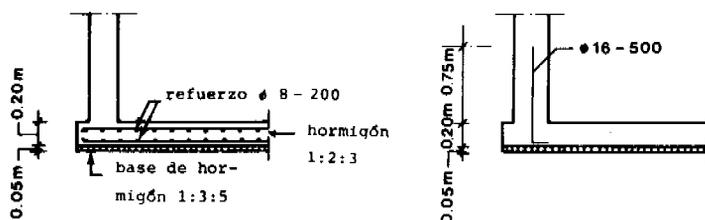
Solado de cimentación para filtros de paredes verticales
